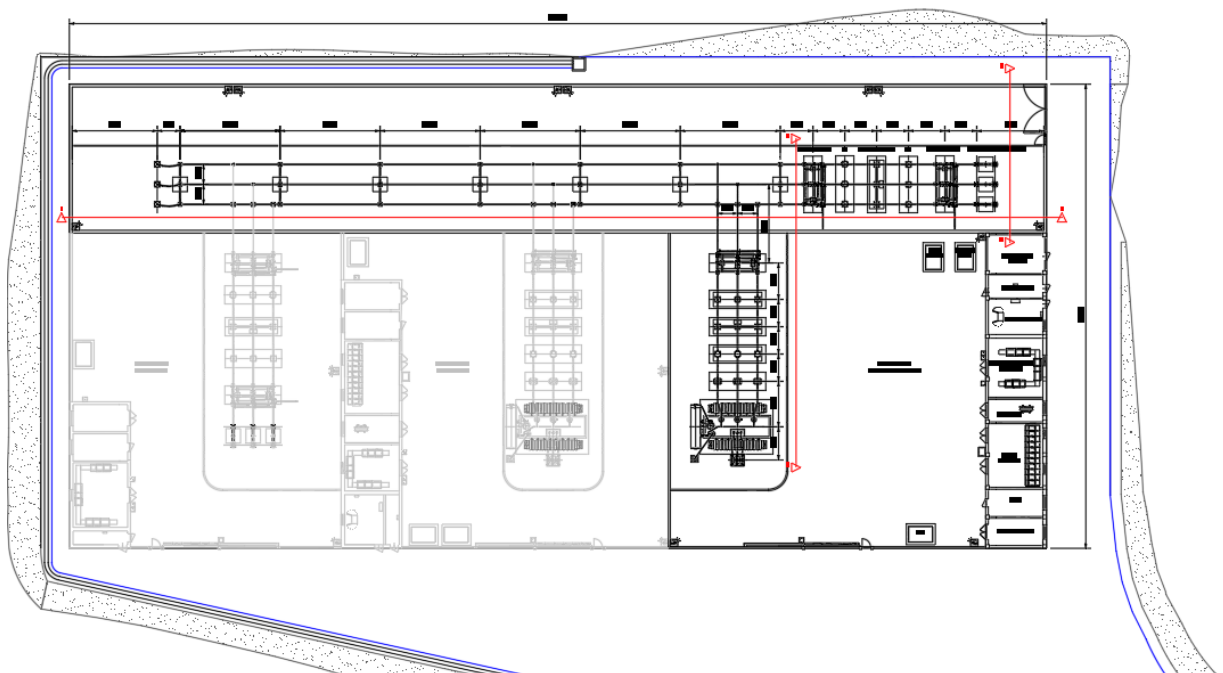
Planimetria Sottostazione multiutente 150/33 kV
